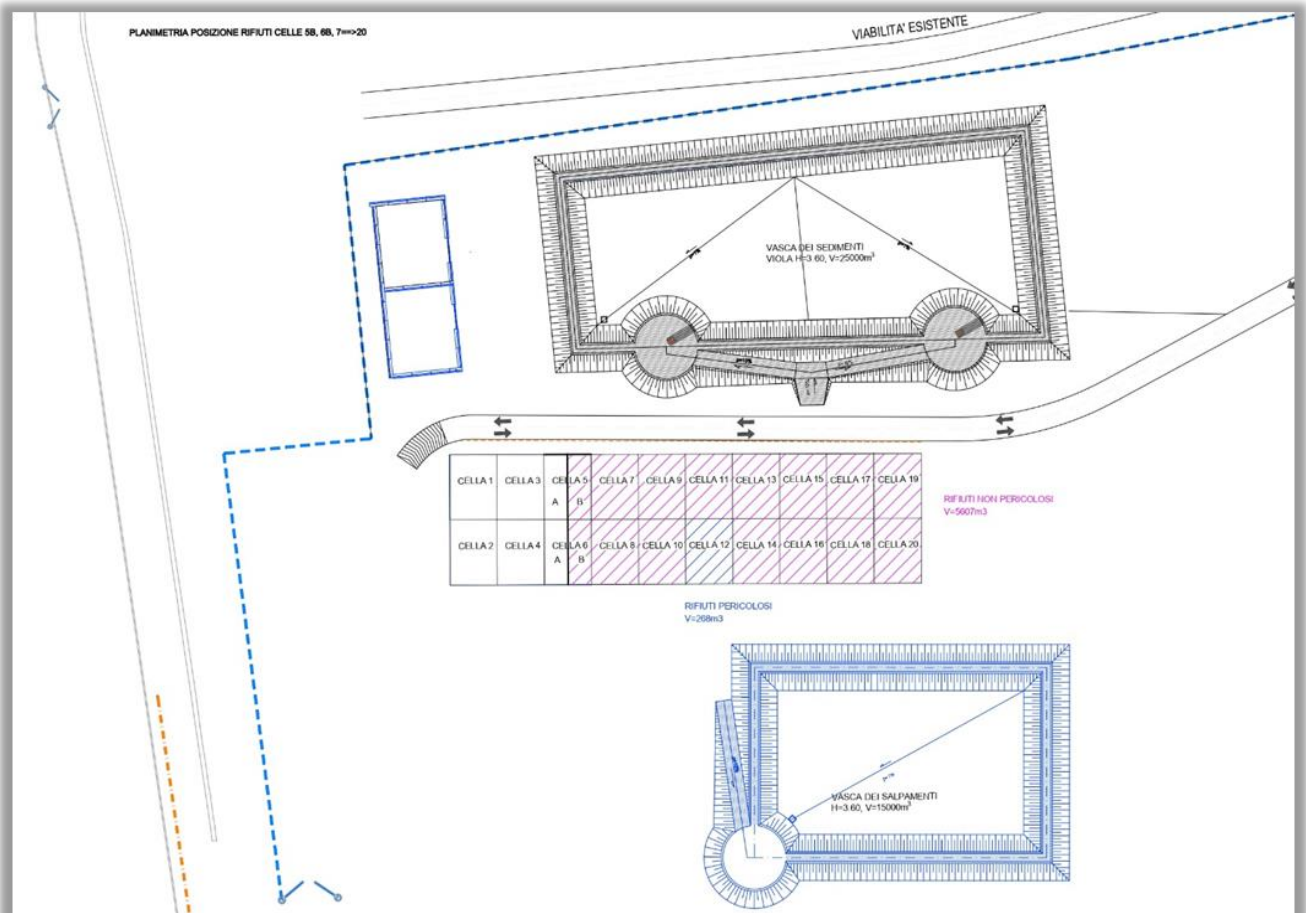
Planimetria con ubicazione celle di caratterizzazione dei materiali stoccati provenienti dagli scavi
